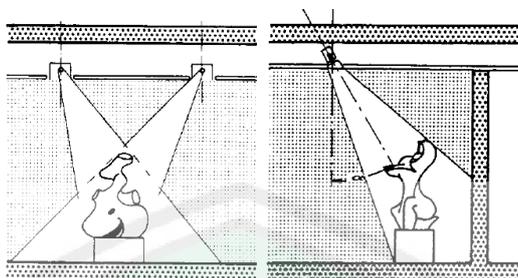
2 lampu penyorot pada 2 dimensi
